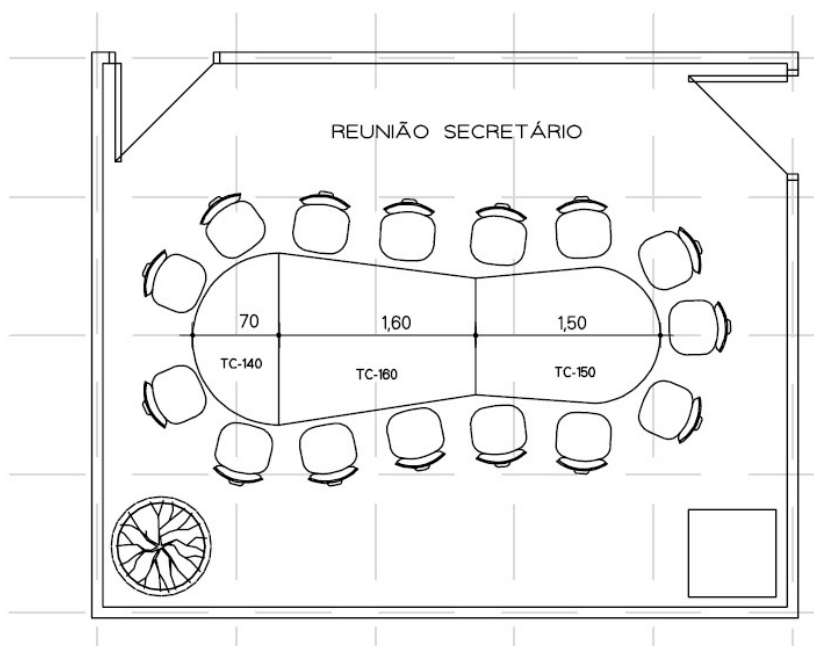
Planta baixa sala reunião Secretário. Área aproximada: 25m² (Fonte: Plano Diretor do CAFF)
